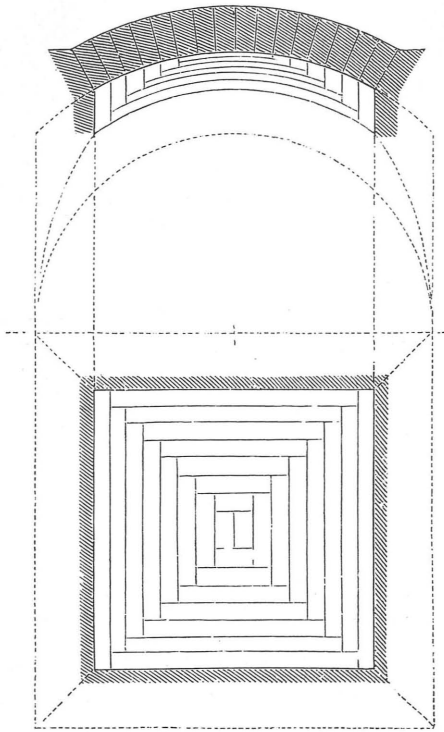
Bóveda esférica rebajada sobre planta cuadrada construida por hojas
